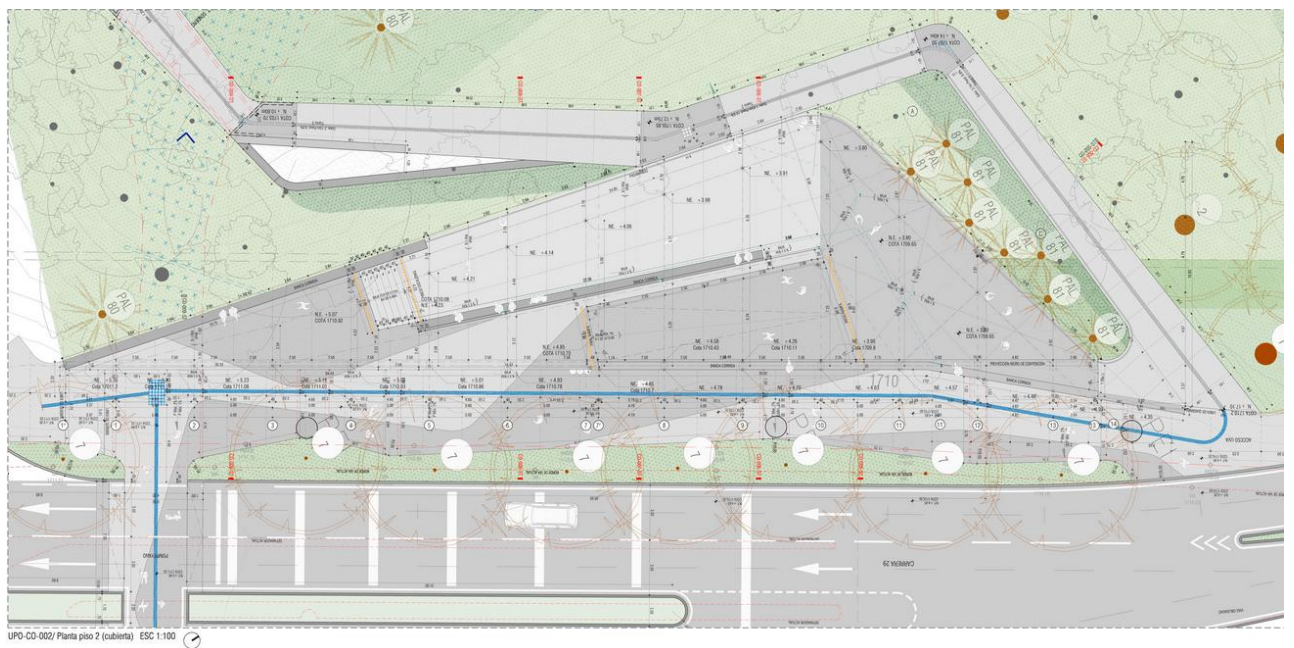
Planta de Cobertura do Edifício Administrativo. Fonte: site EPM.
